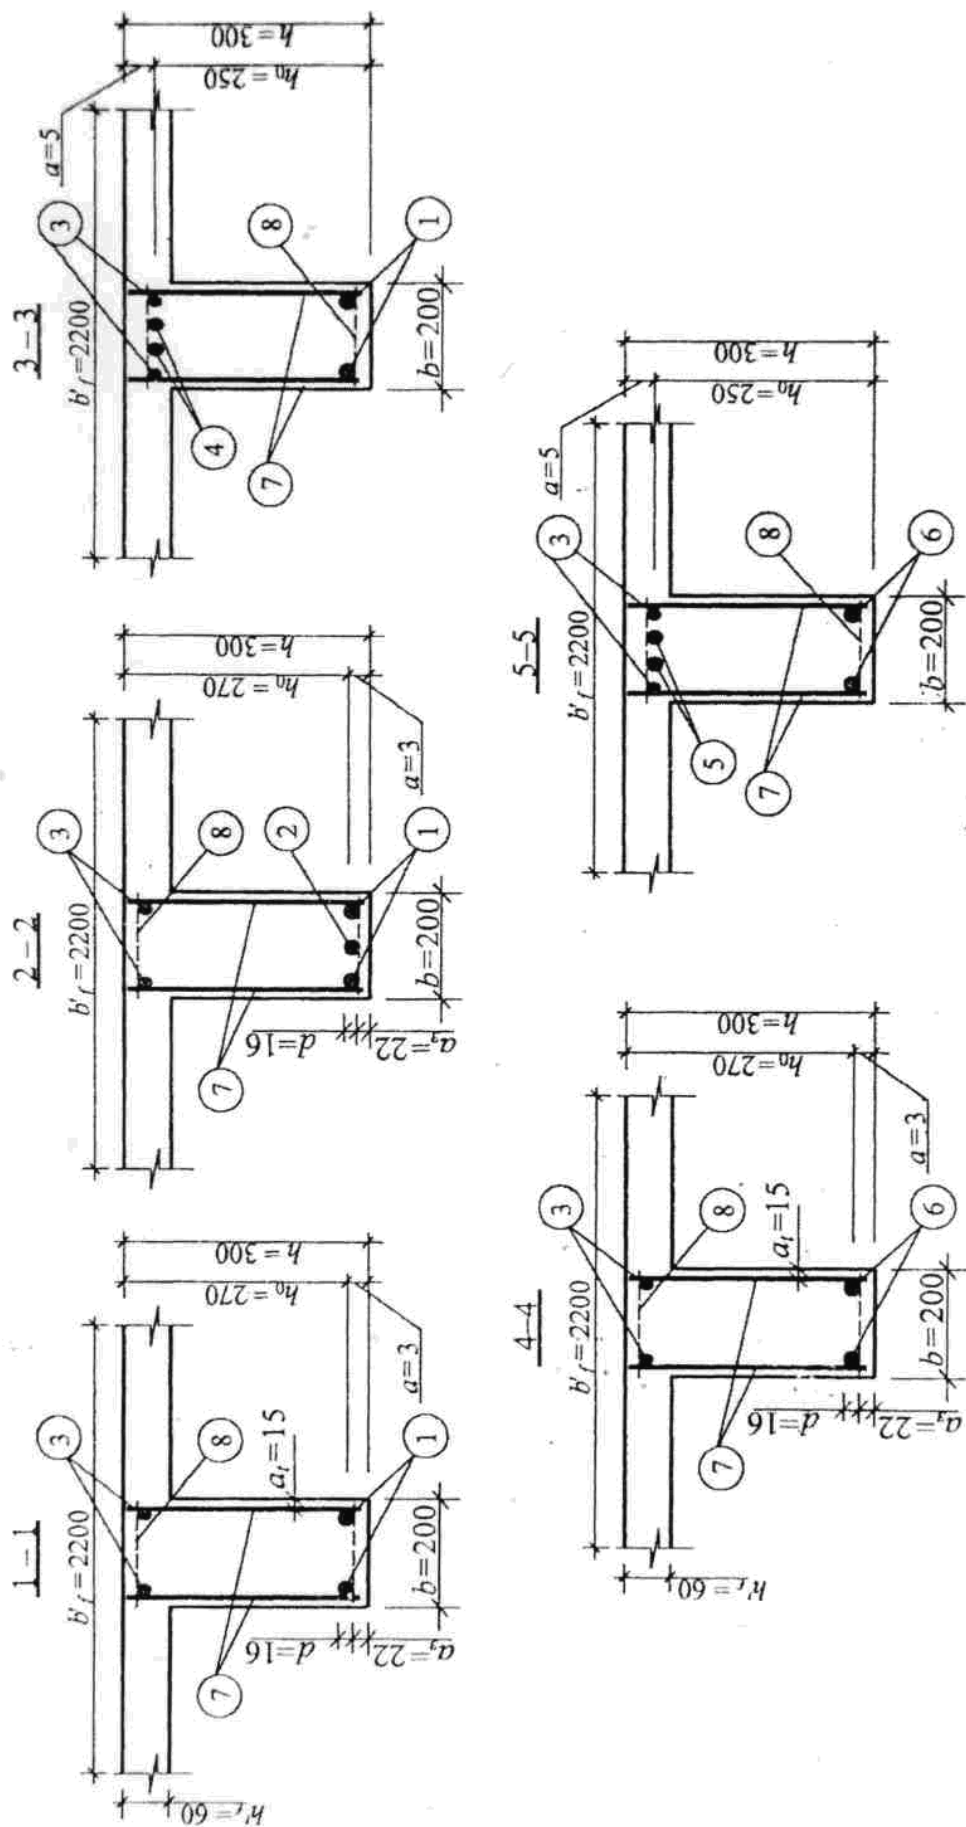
Армирование изгибаемых элементов товарного сечения:
